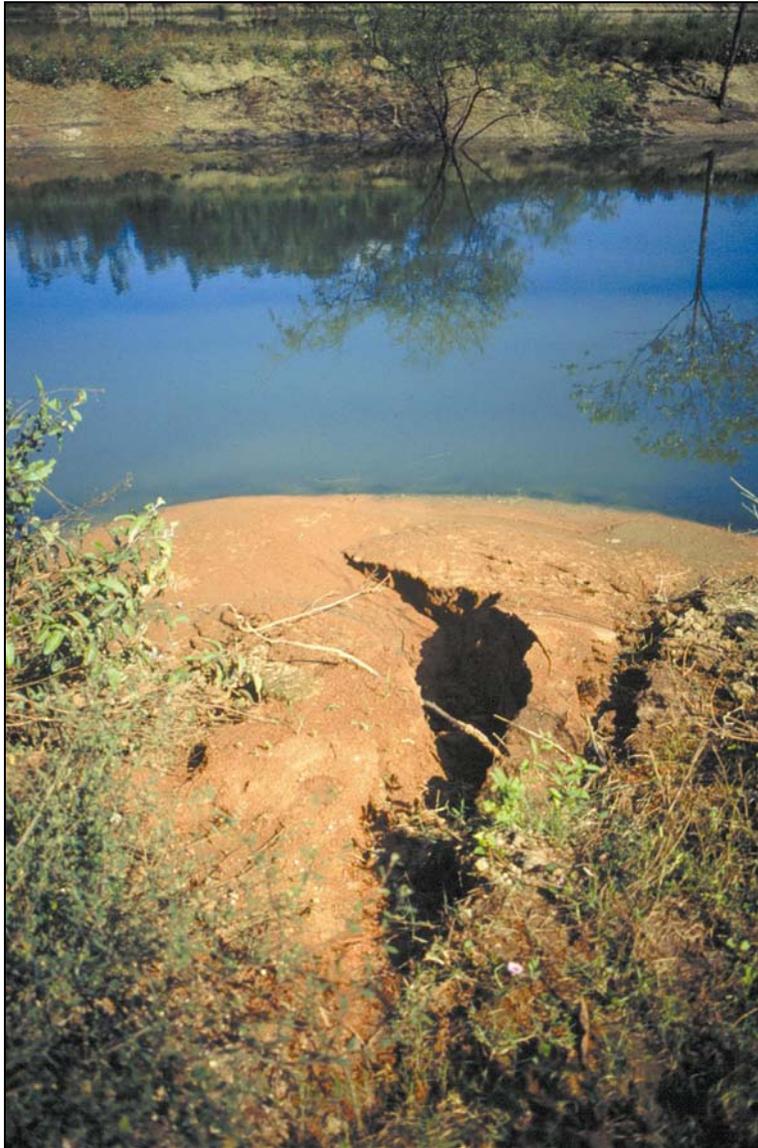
El escurrimiento de agua pluvial tiene que ser controlado para proteger el terraplén y los taludes de una laguna. En esta laguna de maduración el escurrimiento de agua pluvial no fue controlado y está causando erosión al talud interior (Zaragoza, El Salvador).
